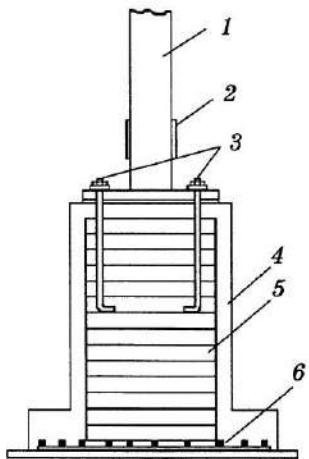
Соединение металлической колонны с арматурой железобетонного фундамента:
